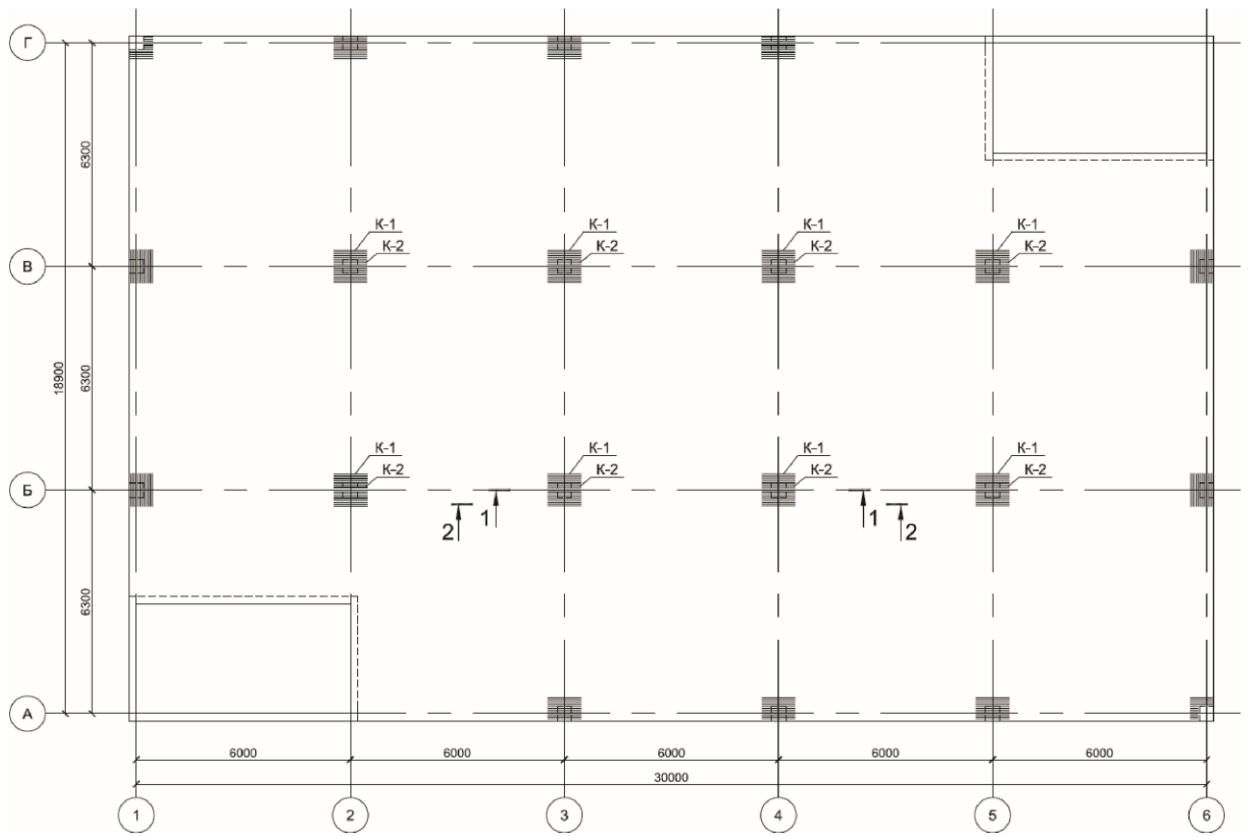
Додаткове армування плити перекриття в зонах продавливання
